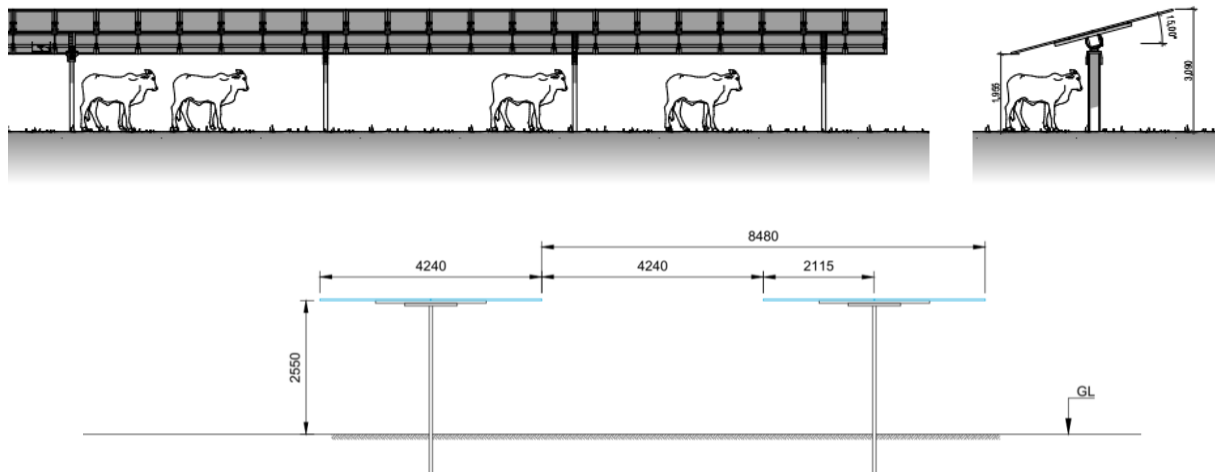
Schéma des bovins sous panneaux réglés à 15° & coupe transversale des trackers en position plane.
